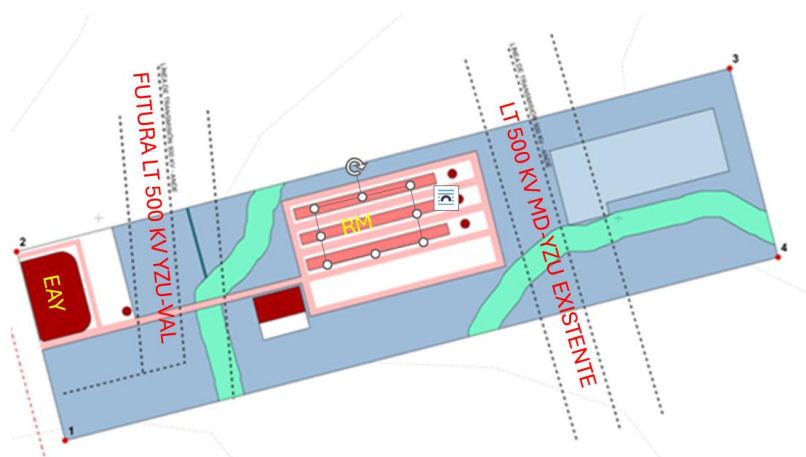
Planta de ubicación de los componentes del Proyecto dentro del inmueble
